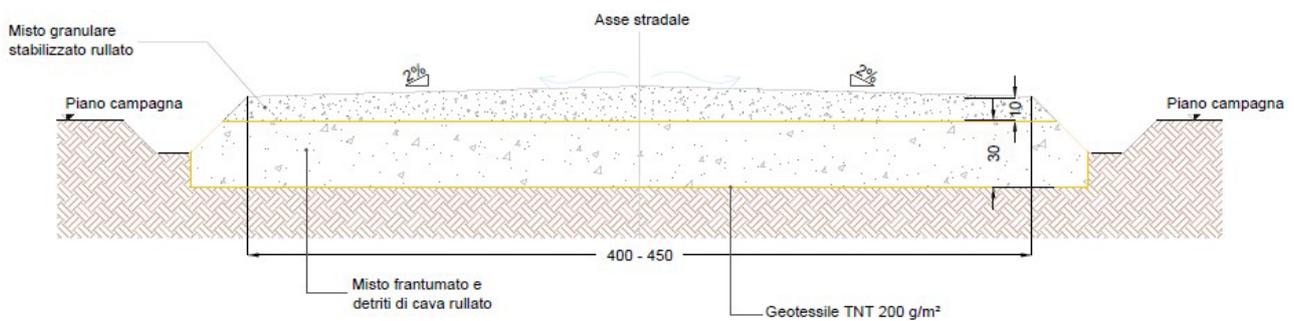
Sezione tipo di strada bianca a livello - misure in cm
